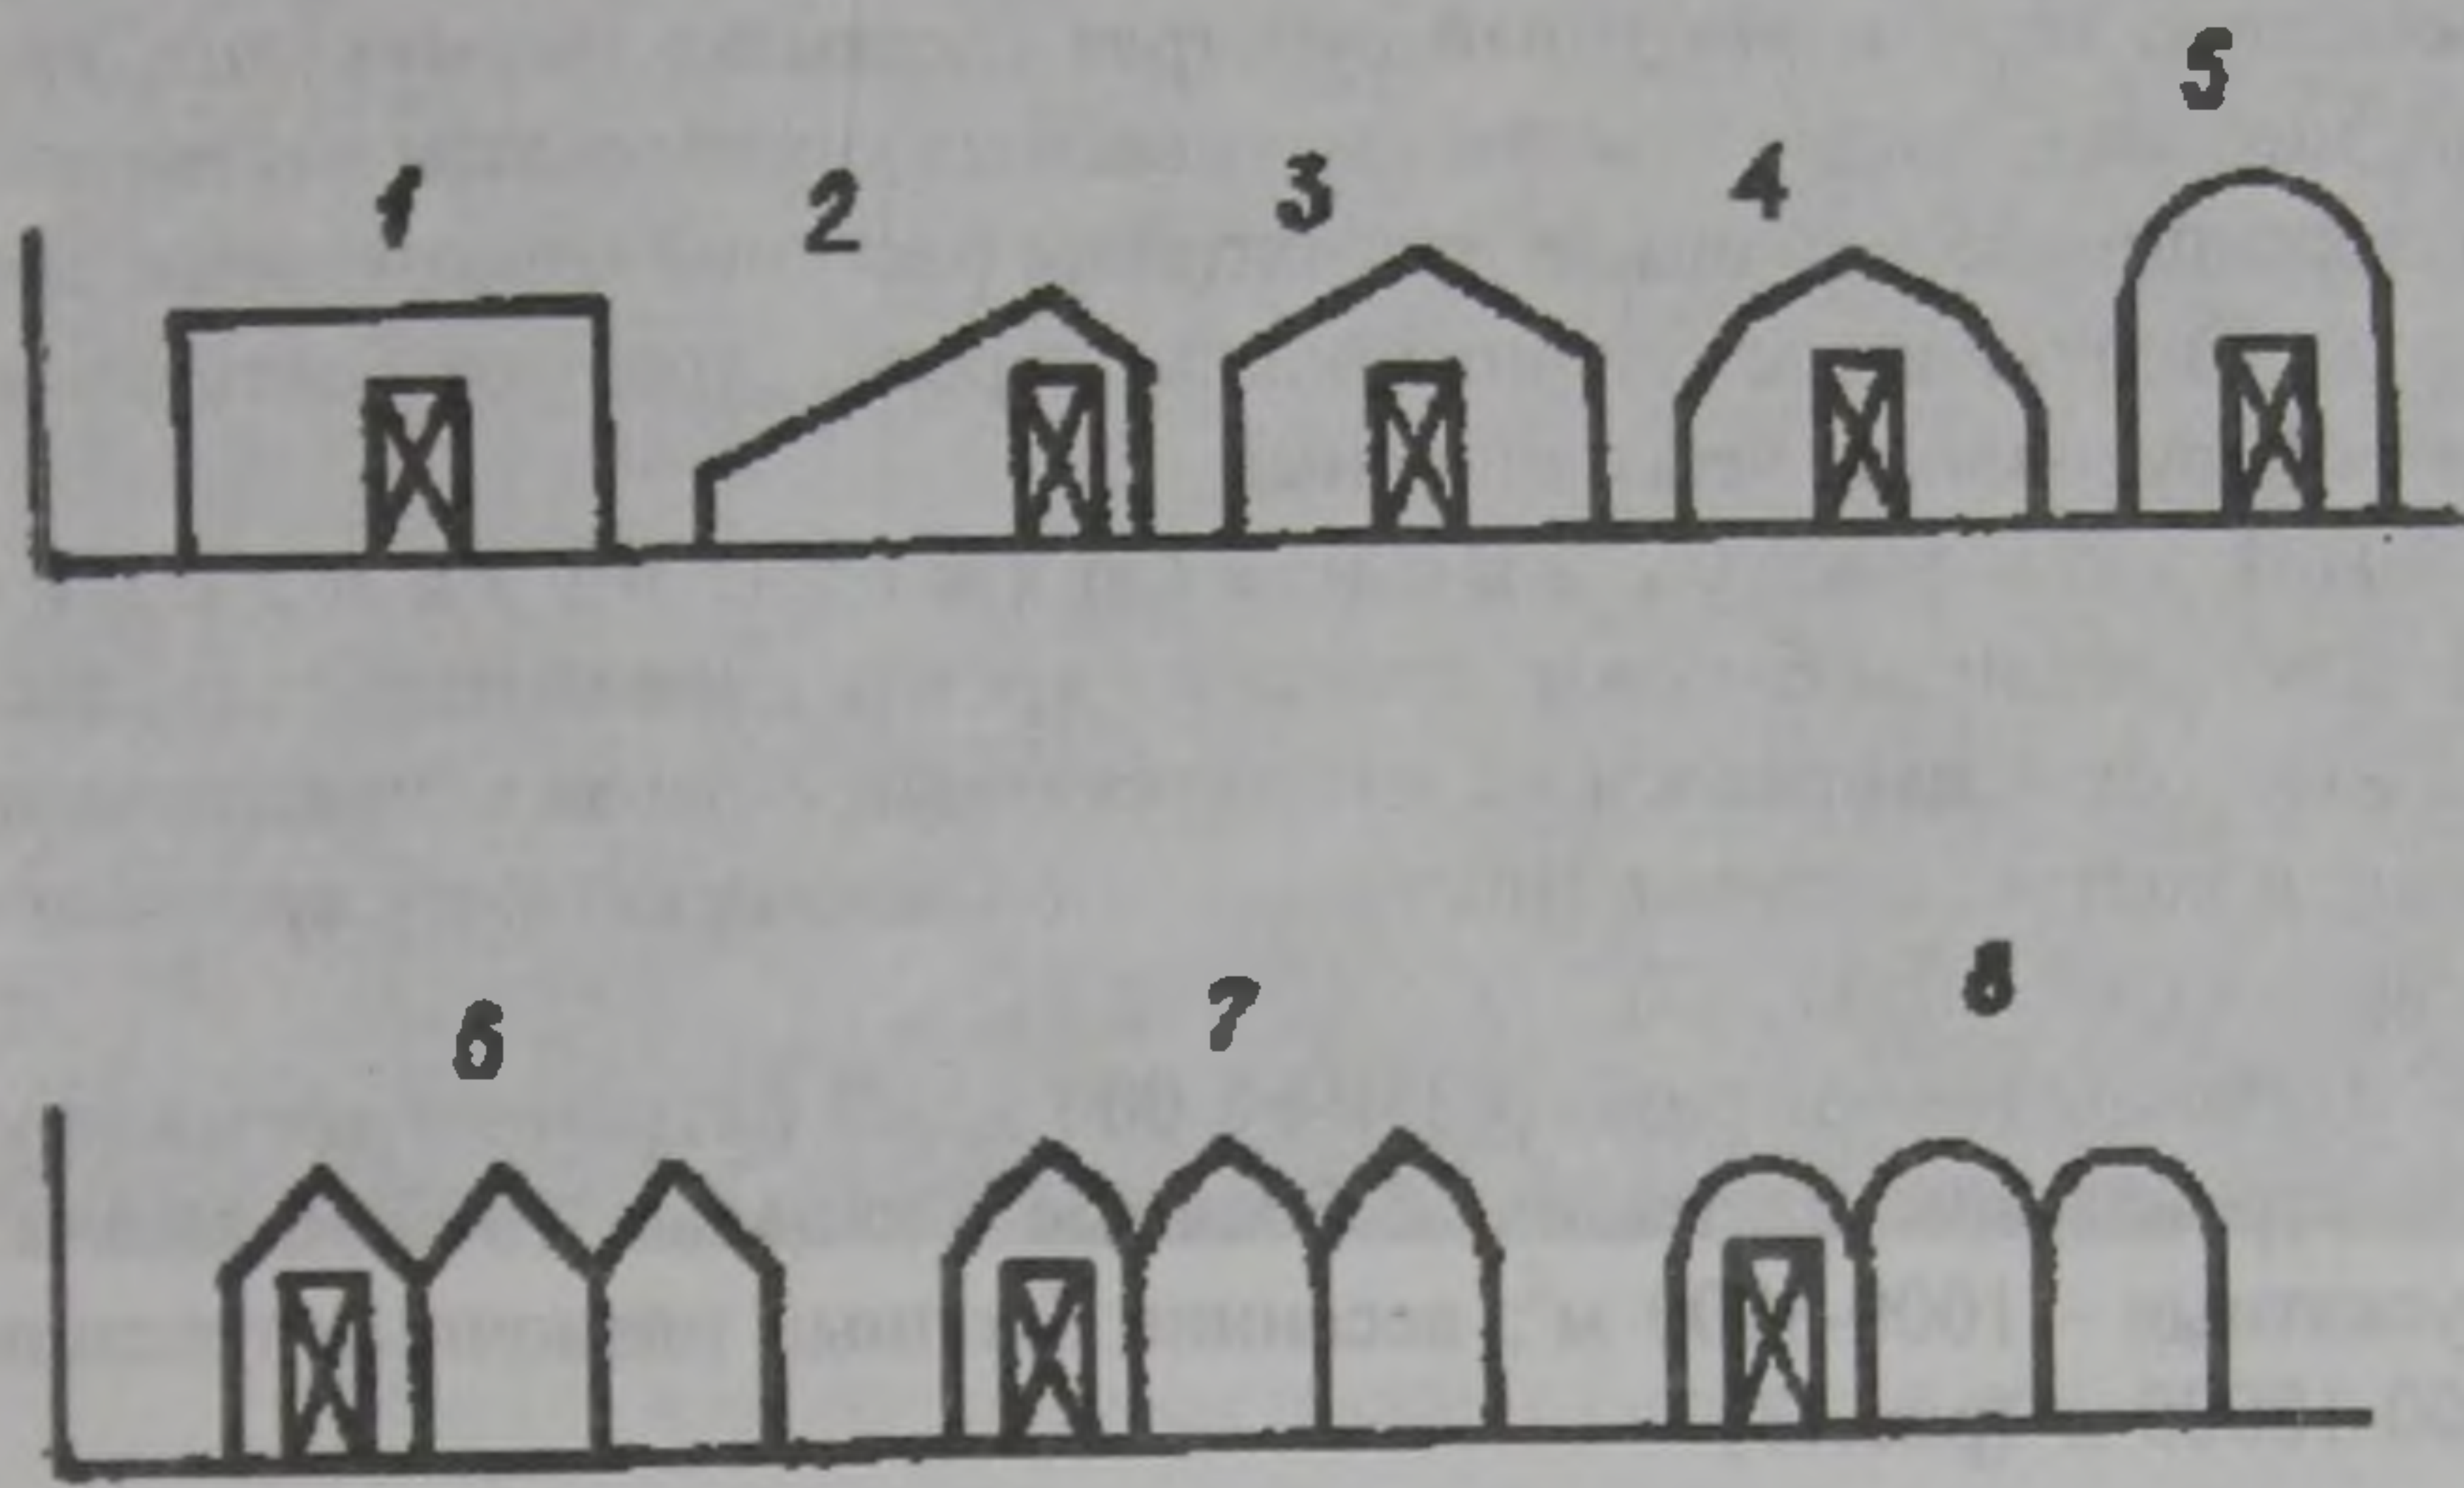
Типы кровли теплиц. Однозвенные: 1 - плоские (гидротеплицы); 2 - однокатные (гелиотеплицы); 3 - двускатные; 4 - полигональные; 8 - арочные.
